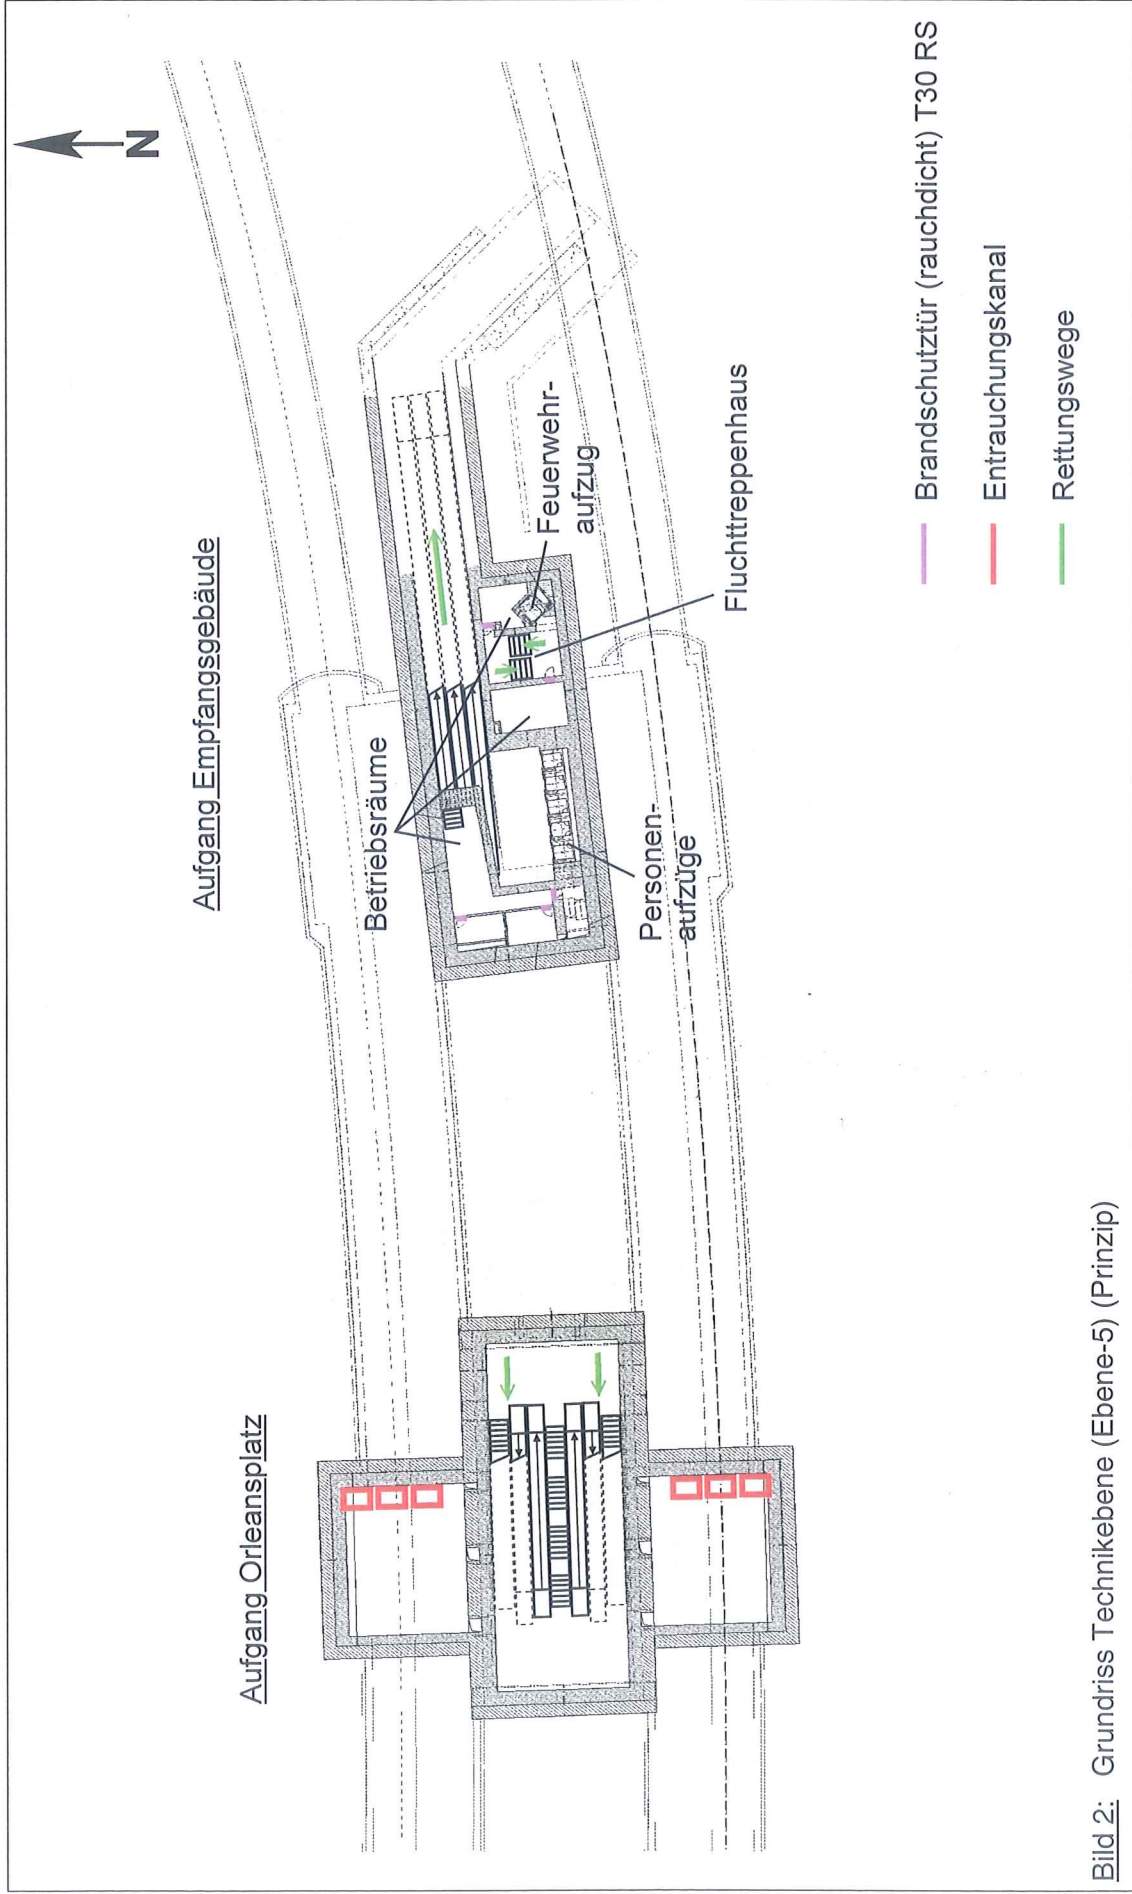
Grundriss Technischebene (Ebene-5) (Prinzip)
